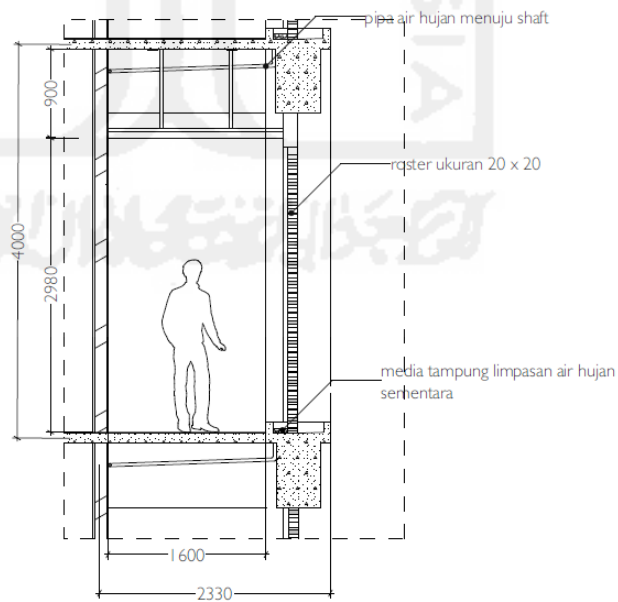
zona penghawaan alami pada lantai tipikal
